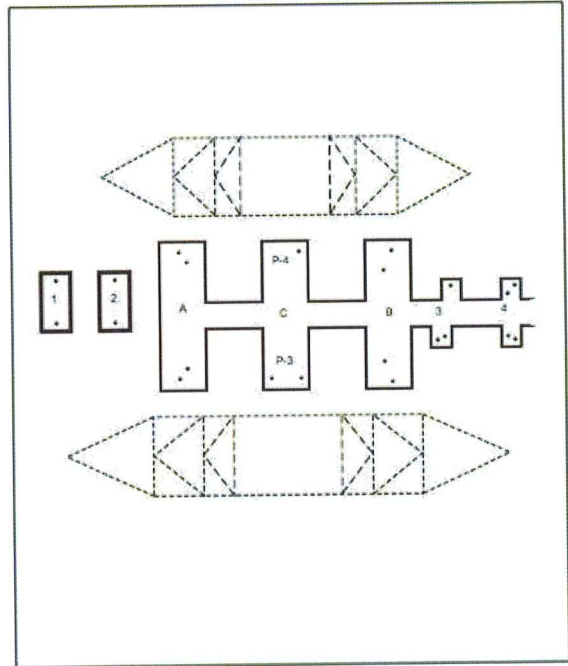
Esquema dos dólfinos do pier norte apresentado no Port Informat
